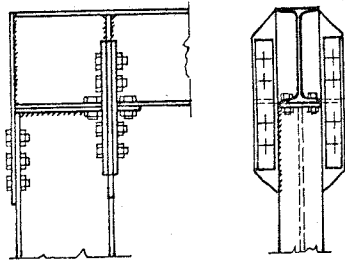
Empotramiento de estructuras metálicas en estructuras de hormigón armado
